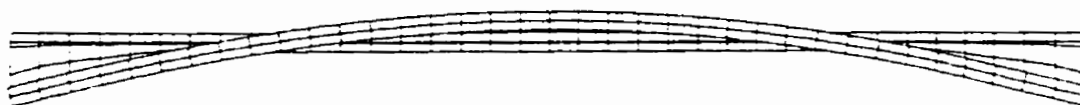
Poutre avec effet de tablier sous charge constante, vue en plan
